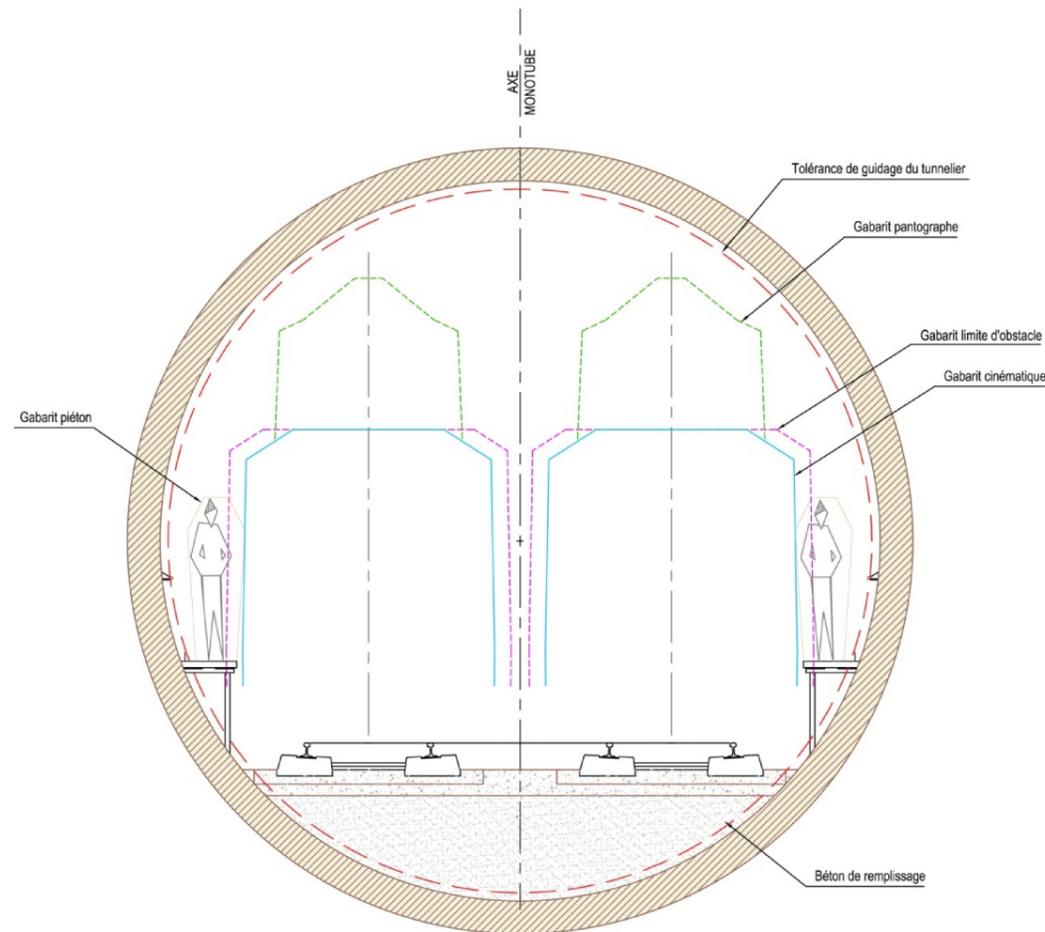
Coupe type du tunnel à deux voies en alignement droit
